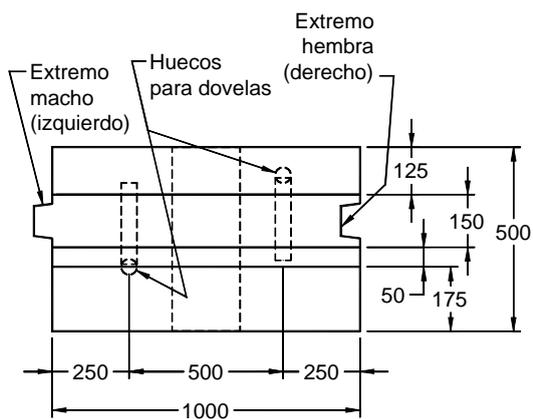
Geometría de los tramos terminales, prefabricados, para barreras bidireccionales y detalles del machihembrado y de los orificios para anclajes
